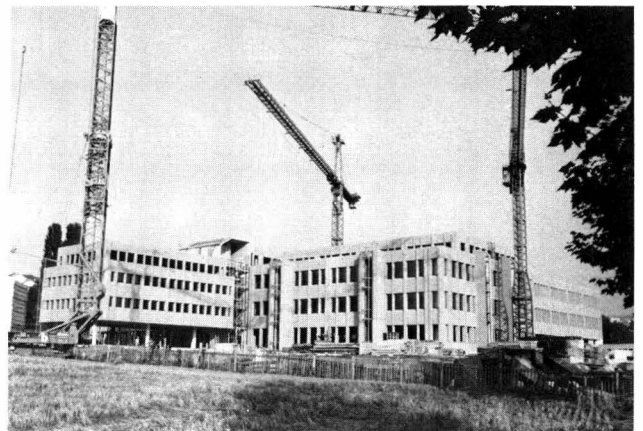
Gesamtansicht der ersten Etappe – Vue d'ensemble de la 1ère étape – Overall view of the first stage
